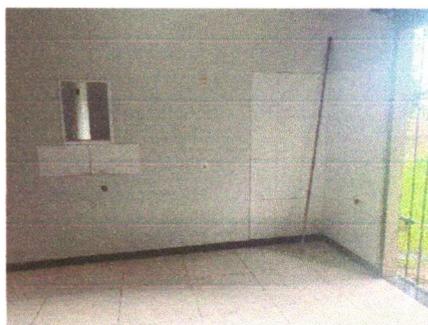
FUNDOS DO SALÃO DO PAV. TÉRREO.
